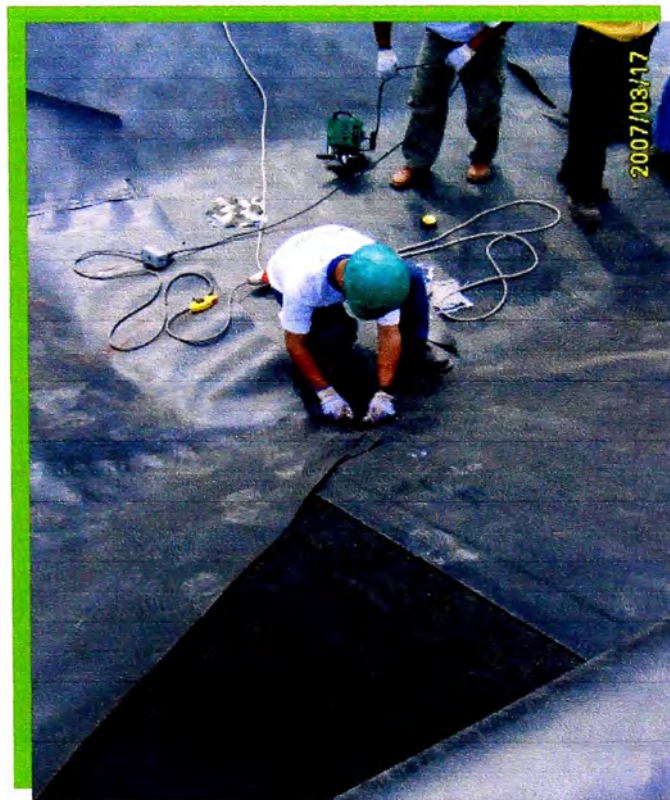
Verificando la soldadura por termofusión.
